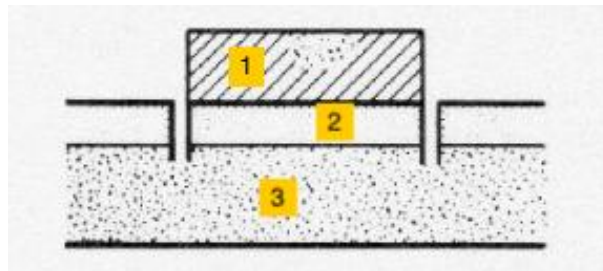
Esquema em corte da incisão para realização do arrancamento por tração [11]: 1 – pastilha metálica; 2 – argamassa de colagem; 3 – suporte.
